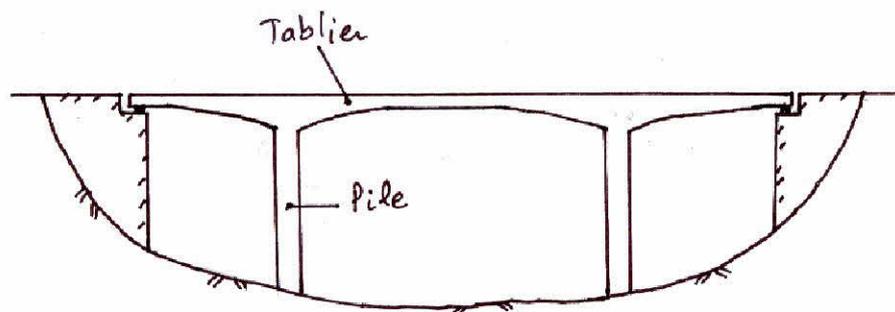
Pont portique ouvert, ou pont à béquilles verticales.
